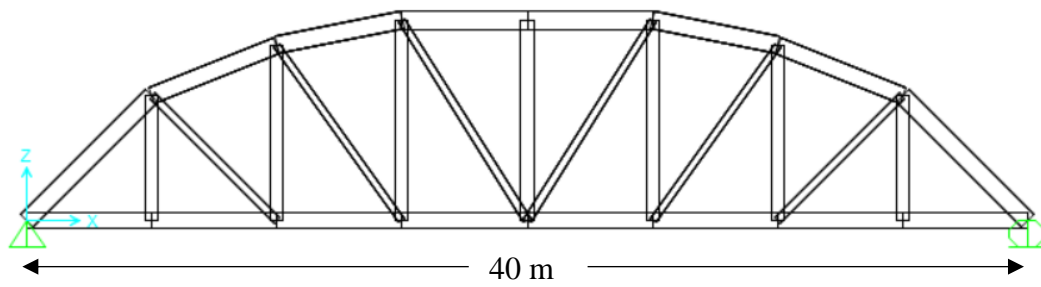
Desain Tampak Bawah Jembatan *Warren Truss
